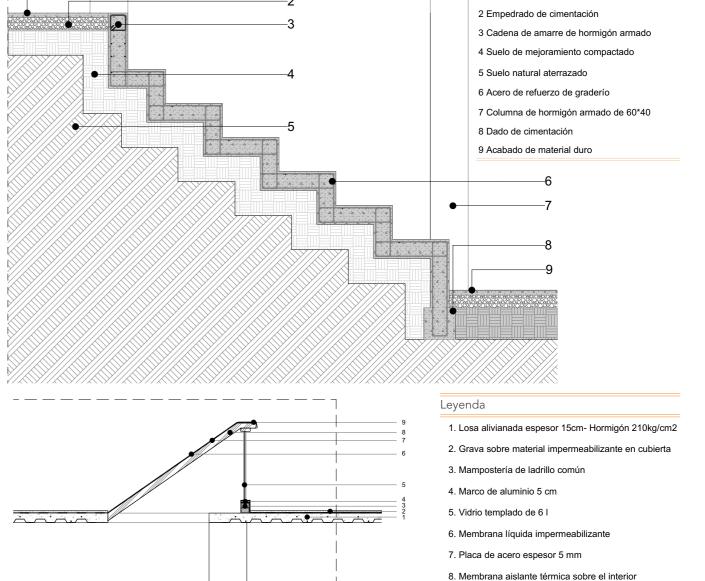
Detalle 03 - 04 Elaborado por: Autor
